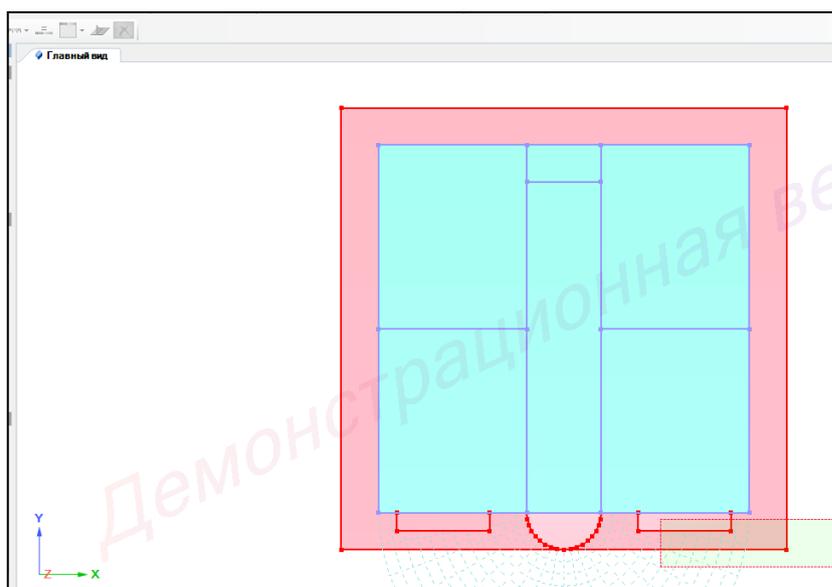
Выделение фундаментной плиты, стен, плит, колонн балконов
